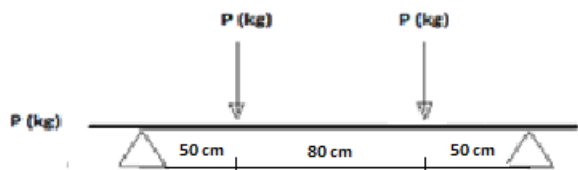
Ubicación de cargas puntuales aplicadas en vigas de concreto reforzado.
